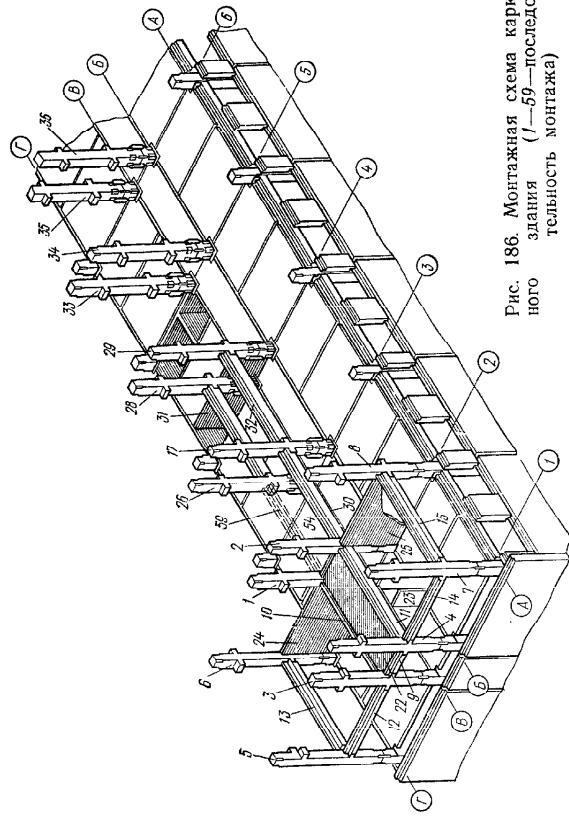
Монтажная схема каркасного здания (1—59—последовательность монтажа)
